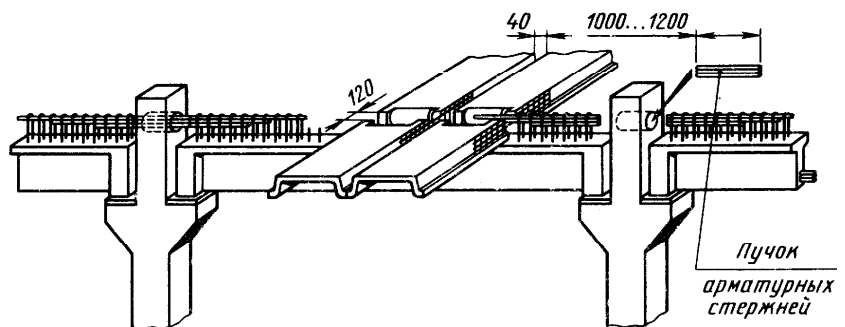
Соединение сборно-монолитной конструкции каркаса здания
